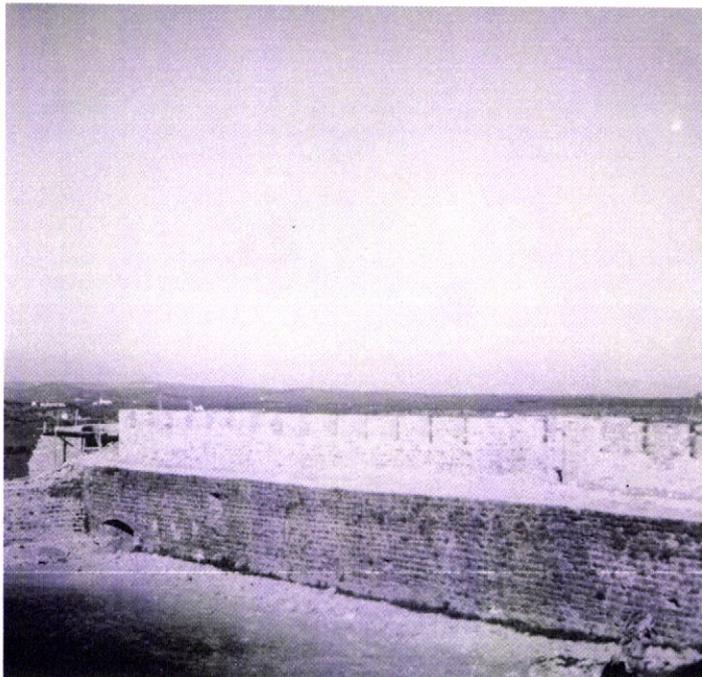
Fortificações de Estremoz. Aspecto da cerca medieval e terreiro (junto da Capela da Rainha Santa Isabel), durante as obras de reconstrução do cubelo do Postigo dos Palhais (16/08/1966) (DREMS 14109)
